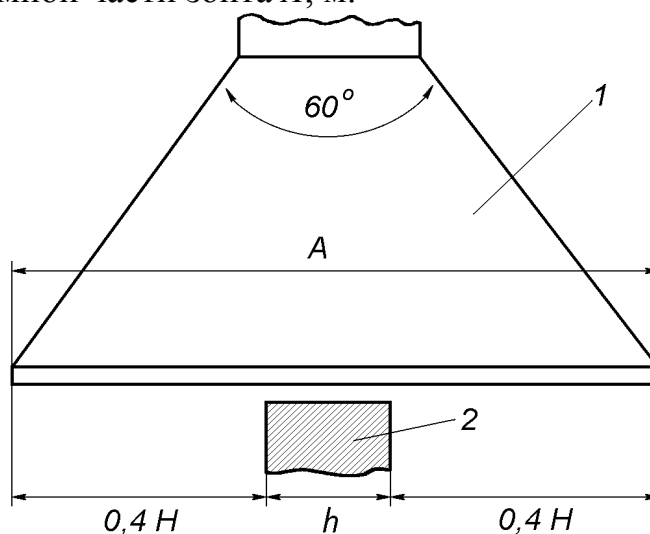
Схема размещения вытяжного зонта над рабочим местом:
